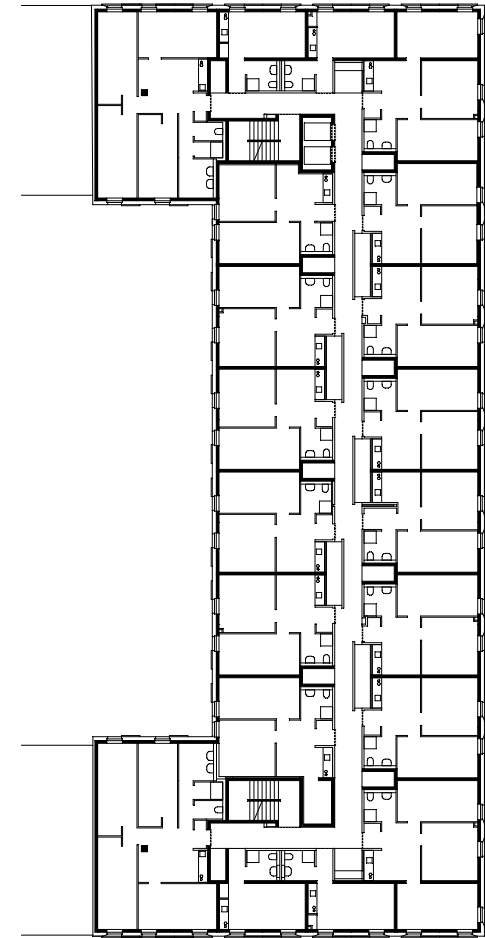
Regelgeschoß Studentenwohnheim Molkerestraße, Baumschlager Eberle
